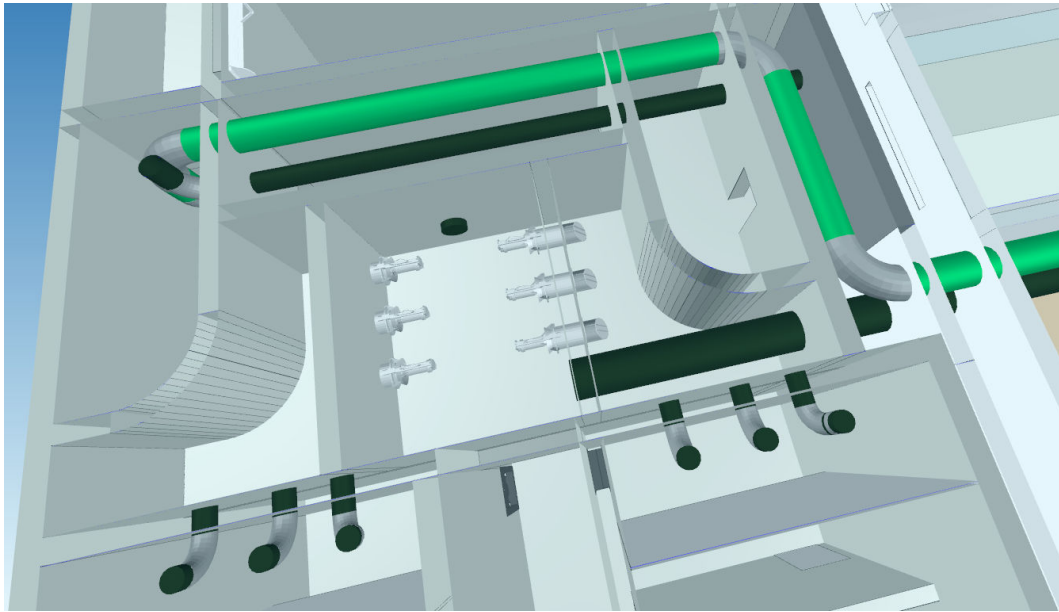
Grundriss Zwischenpumpwerk der Ozonung
